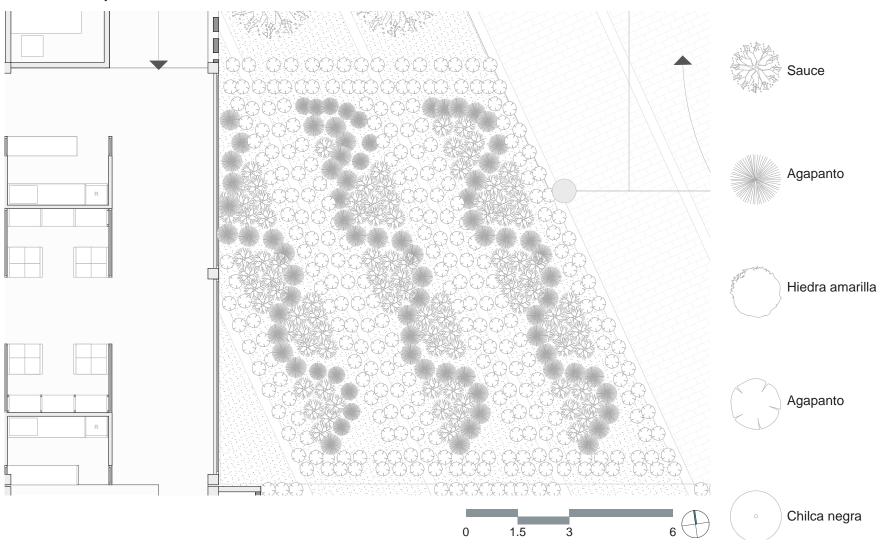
Planta de jardinería tipo 2. Fuente: Autores, 2024
